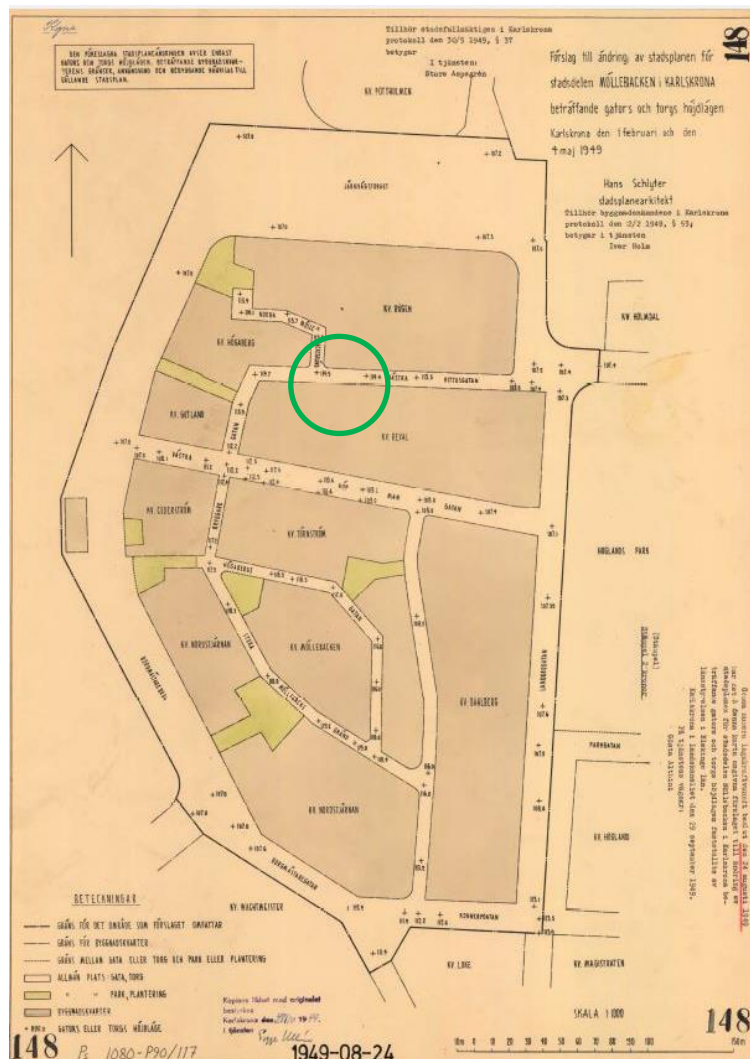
Ändring av detaljplan ÄDP (1080-P90/117). Grön linje visar område som berörs av planändring.
